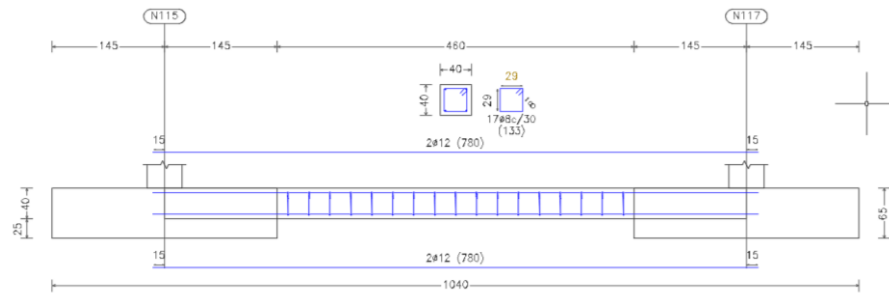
Características de la viga perimetral entre pilares que están a 7,5 metros
